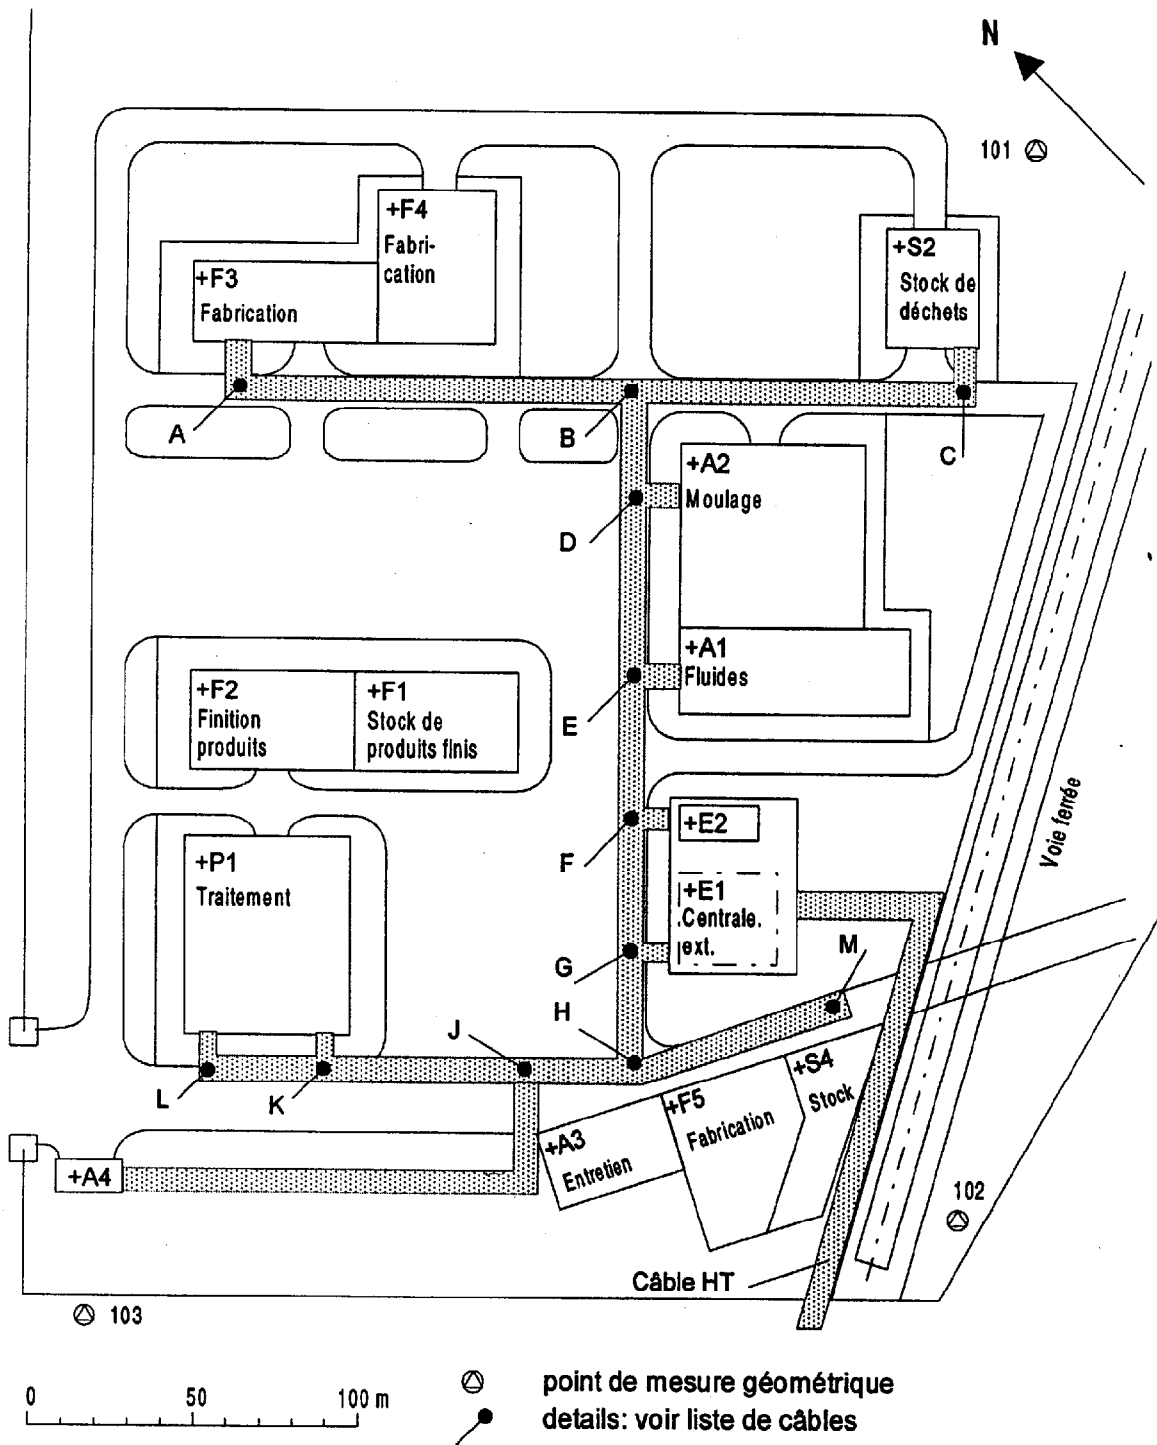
Exemple de dessin de cheminement des câbles sur site
